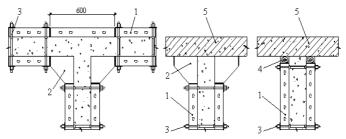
Схема устройства Т-образного участка стены: 1 — щит; 2 — внутренний угол; 3 — винтовой тяж; 4 — деревянная вставка; 5 — забетонированная стена
